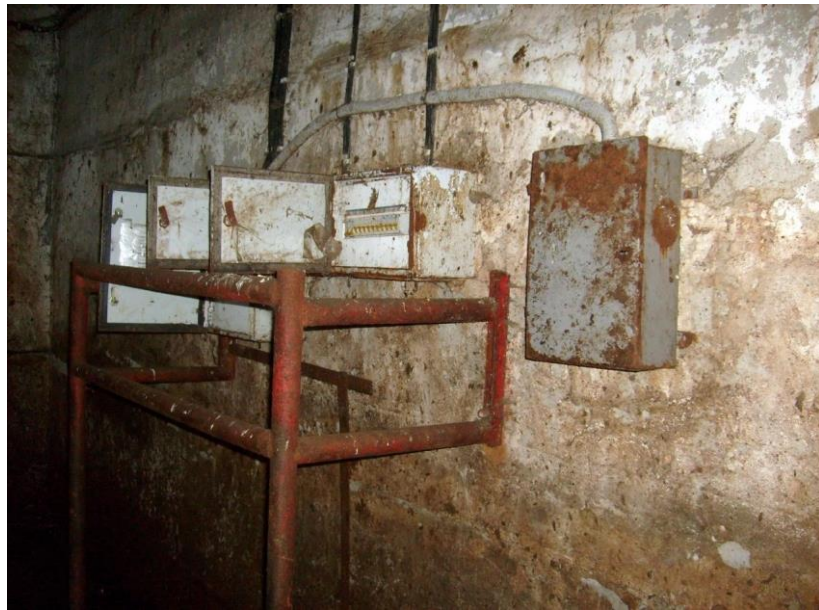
Загальний вид корозійного ураження поверхонь контрольно-пускового електроустаткування корівника
